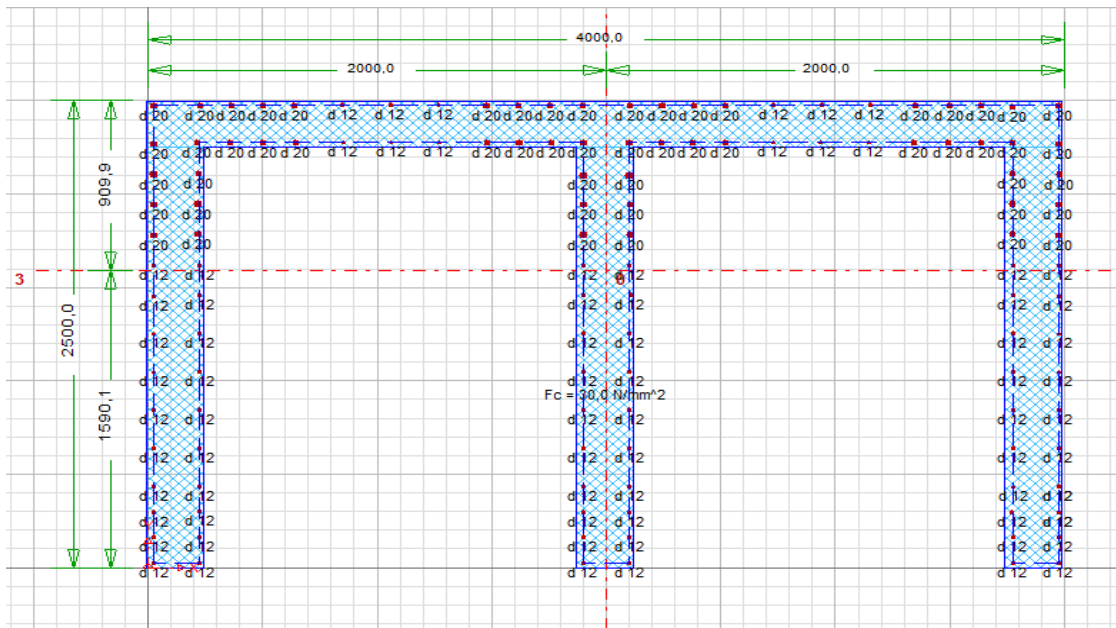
Section de la cage avec un choix de ferrailage final.
